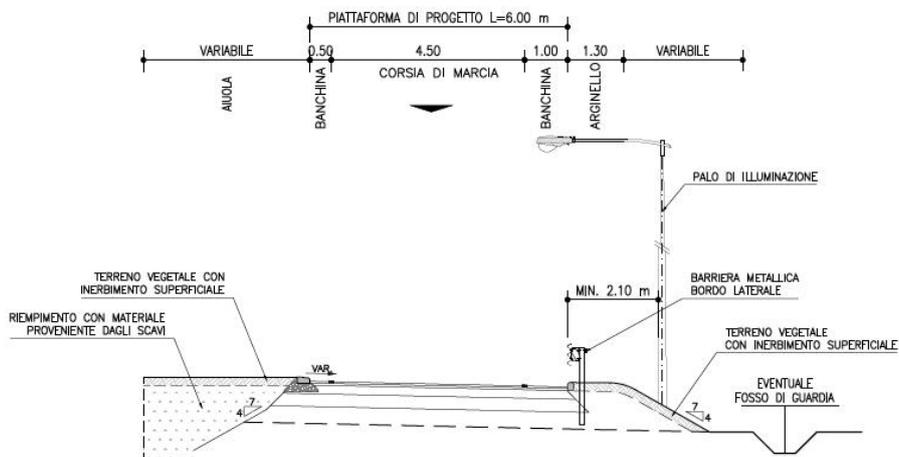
Sezione Tipo ramo di uscita dalla rotonda
